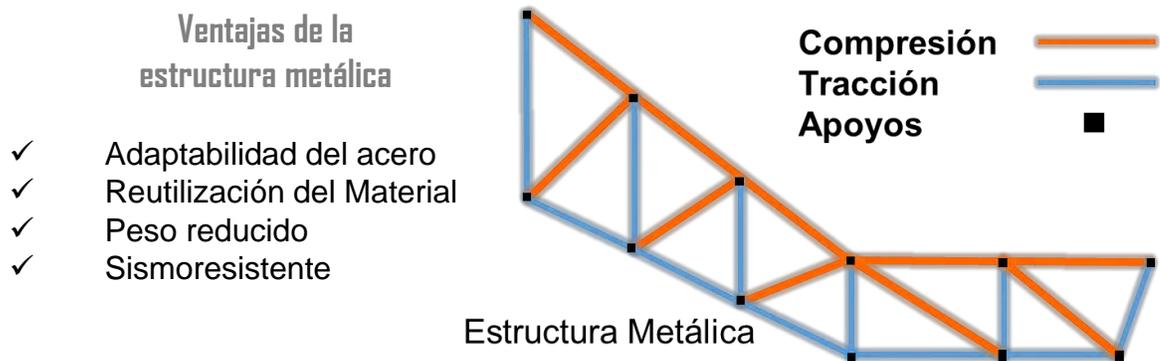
Comportamiento estructural. Fuente: Elaboración Propia
